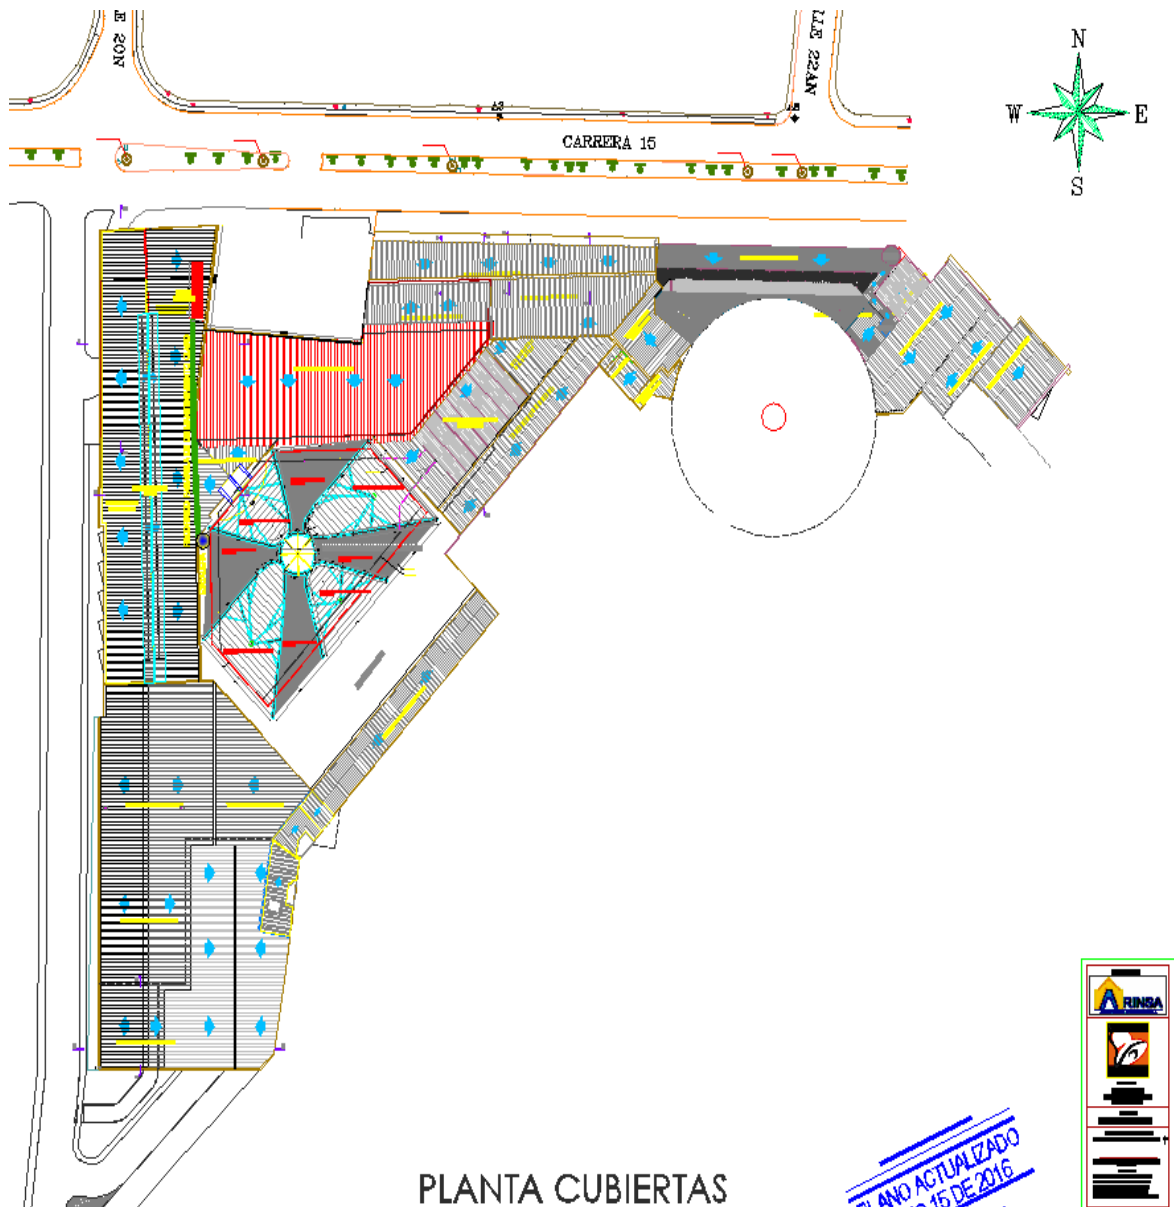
Planta de cubiertas (Fuente: Diseños arquitectónicos ARINSA)
